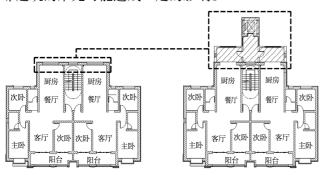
多层住宅北侧增设电梯示意图 Fig. 5 Schematic diagram of adding elevators to the north side of multi – story residential buildings
